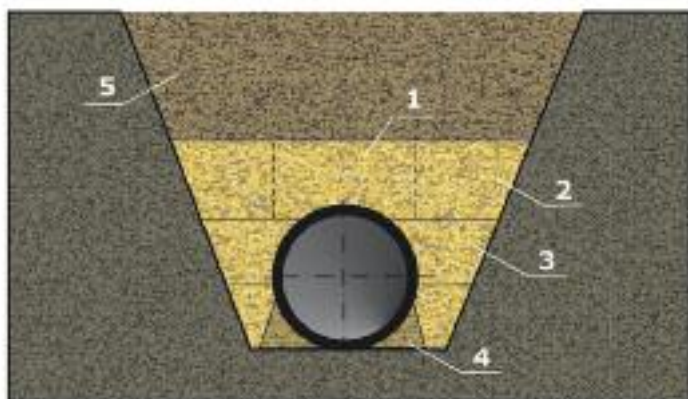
Схема уплотнения грунта при засыпке траншеи:
